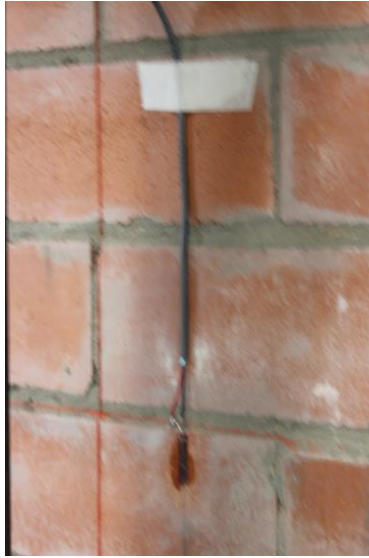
Inyección mortero de relleno en los muros de mampostería. Fuente: el autor
